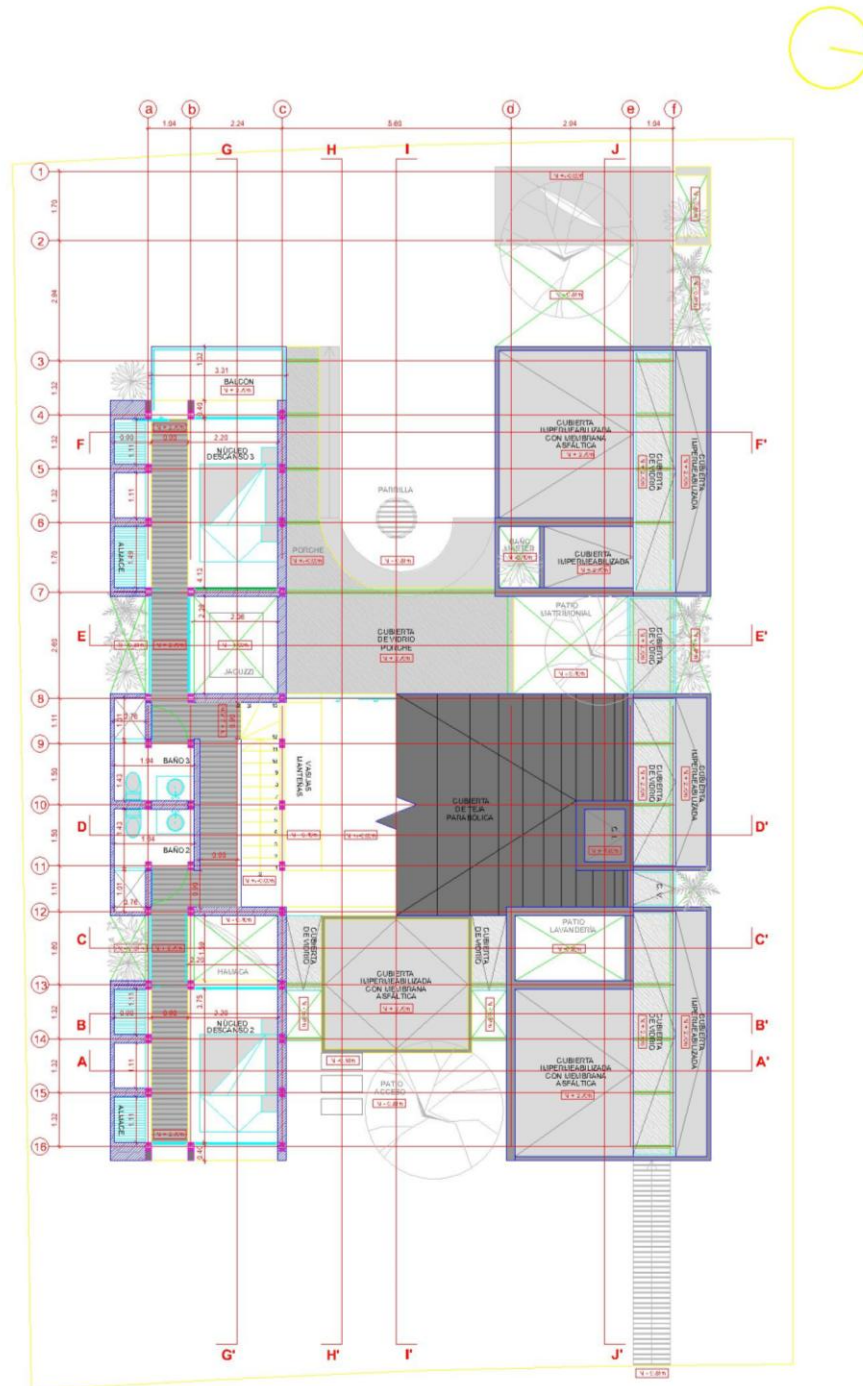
Planos arquitectónicos vivienda de hormigón armadoNota. Proporcionado por arquitecto de la vivienda.
